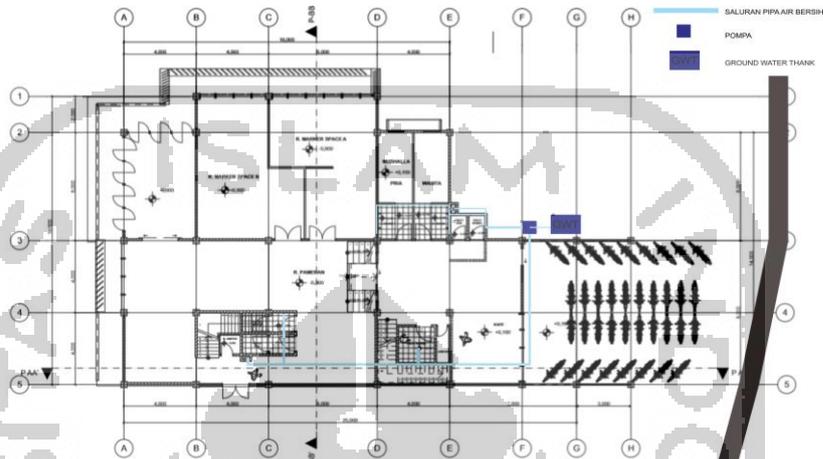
ketinggian lahan parkir dan kafe denah lantai 1
